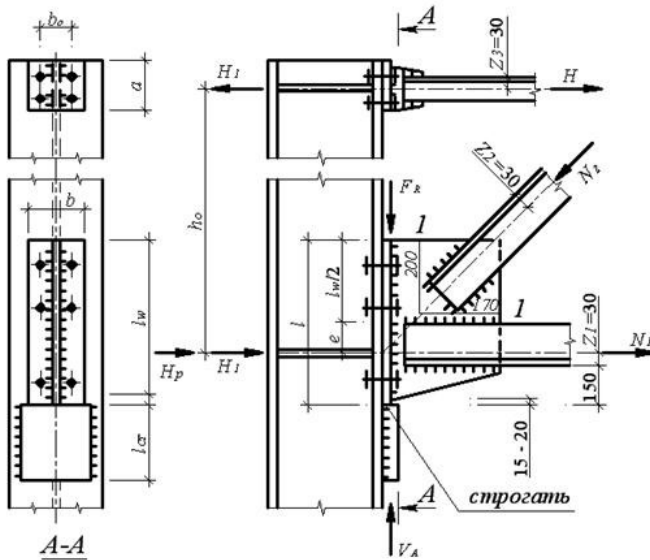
Расчетные усилия в опорном узле фермы при жестком сопряжении с колонной
